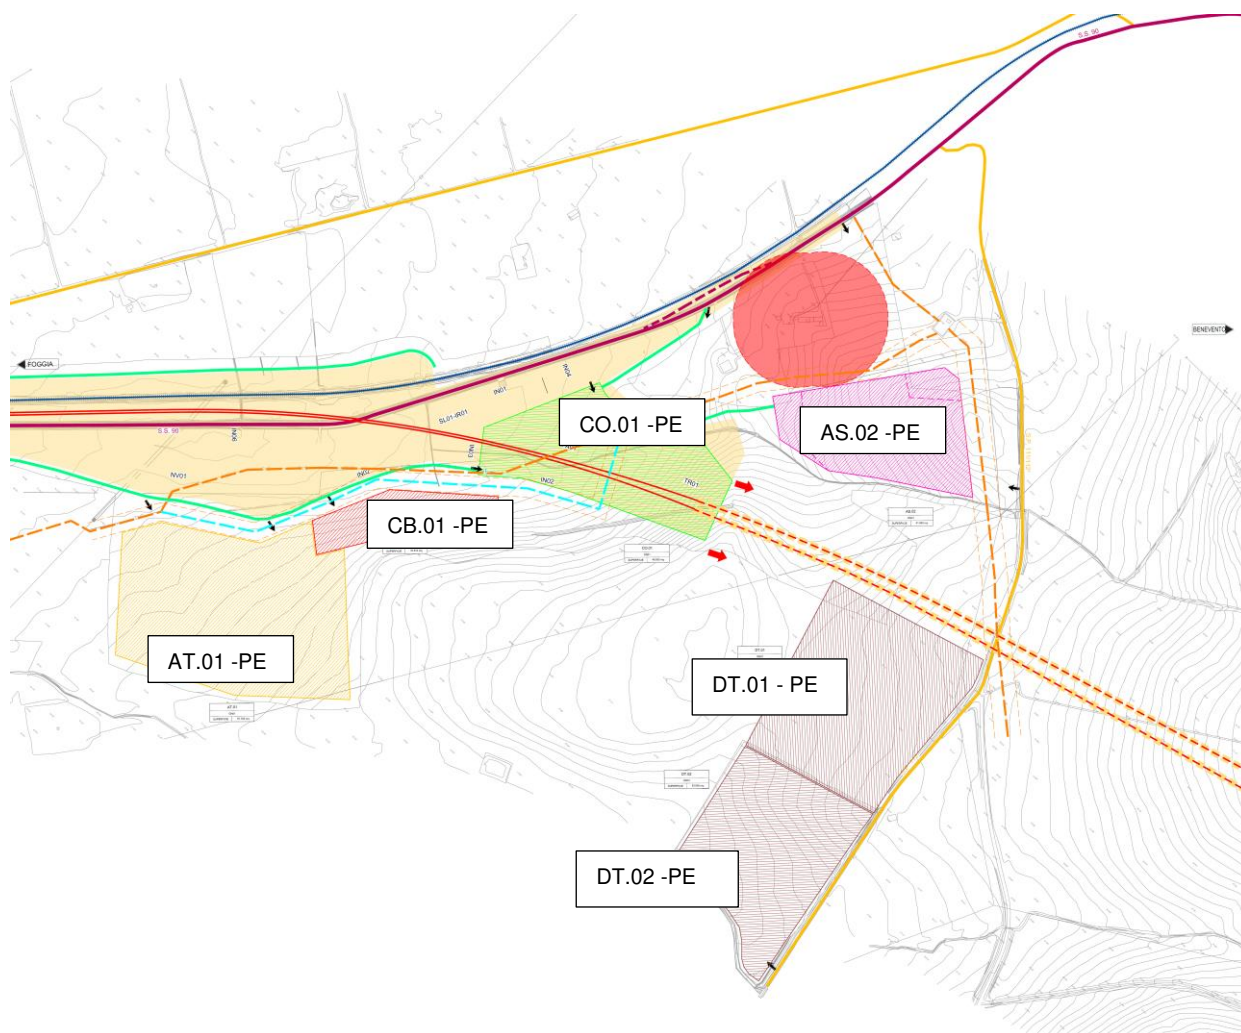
Lay-out complessivo cantieri lato Bari – Progetto esecutivo
